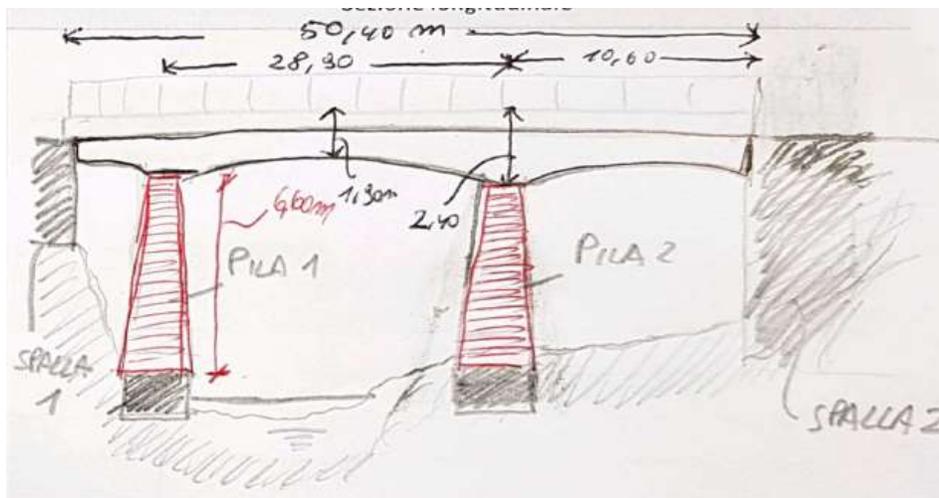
Sezione longitudinale (rappresentazione su scheda da campo, non in scala)
